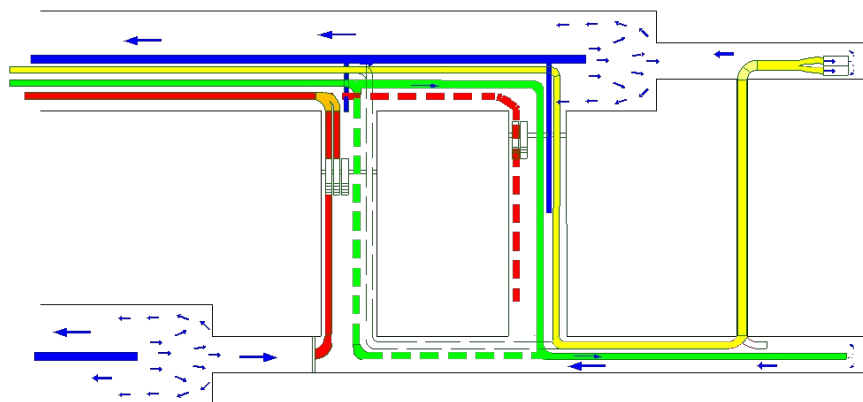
Collegamento e attivazione ventolino cunicolo Sud e ventolino d'emergenza cunicolo Nord; smantellamento barriere non utilizzate e installazione nuove barriere regolatrici del flusso d'aria
